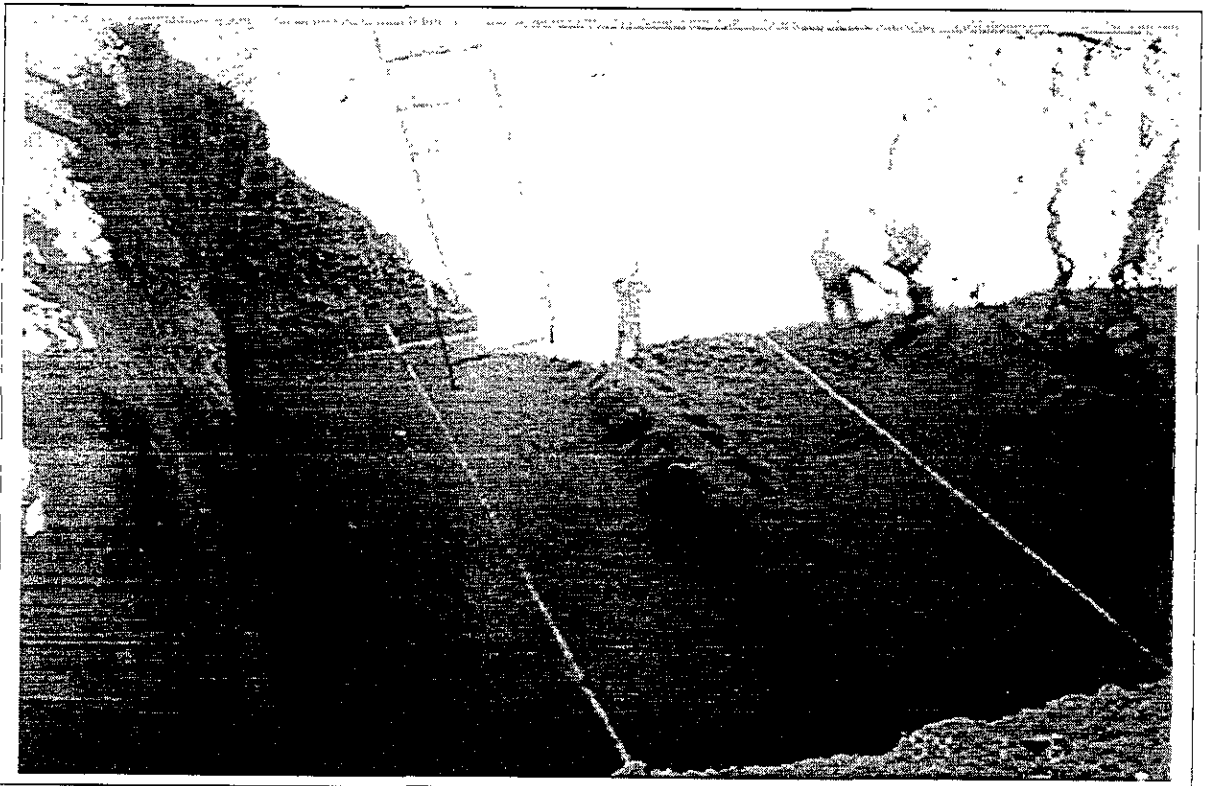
Preparación de cama y trazo para la colocación de los tanques de almacenamiento
